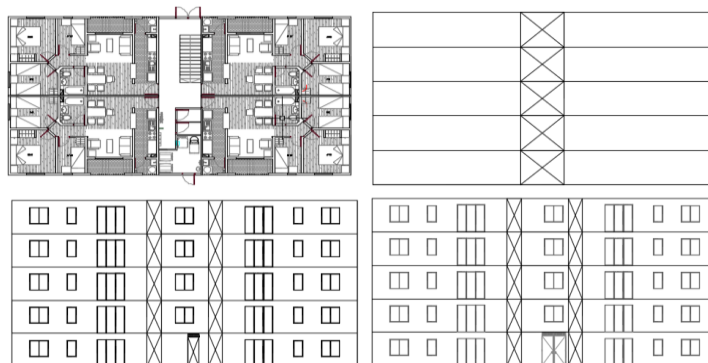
Vista en planta y elevaciones de algunos ejes de la configuración arquitectónica C
